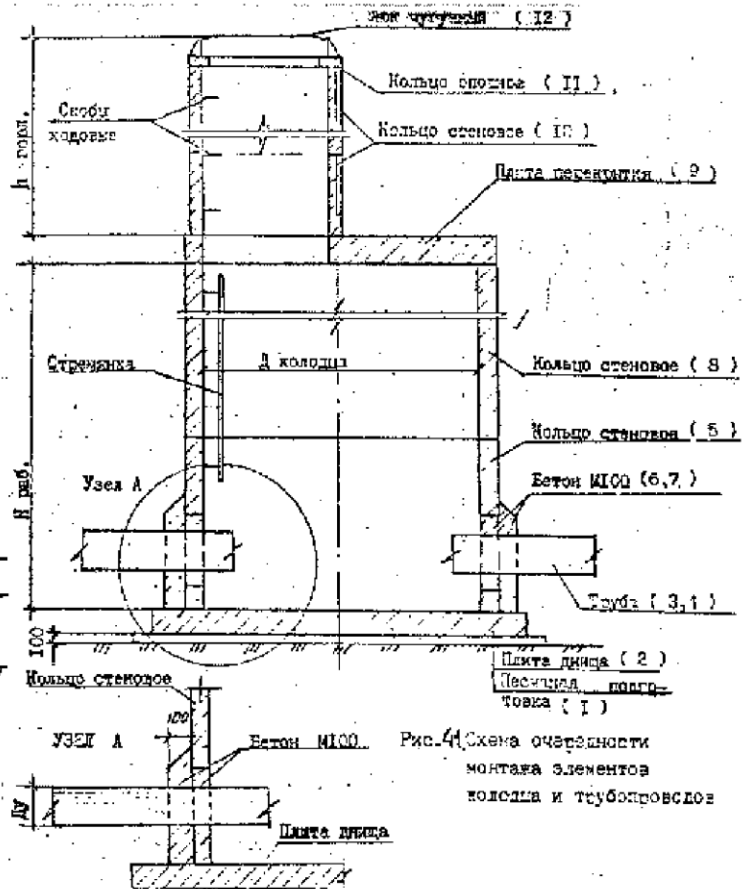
Схема очередности монтажа элементов колодца и трубопровода
